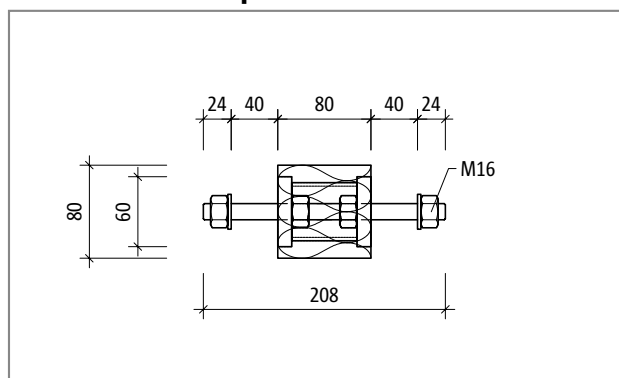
Schöck Isokorb® T tipo S-V-D16: sezione dell'elemento
